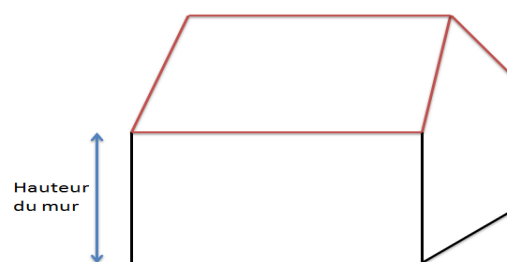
Mesure de la hauteur des murs d'une habitation individuelle de plain pied
